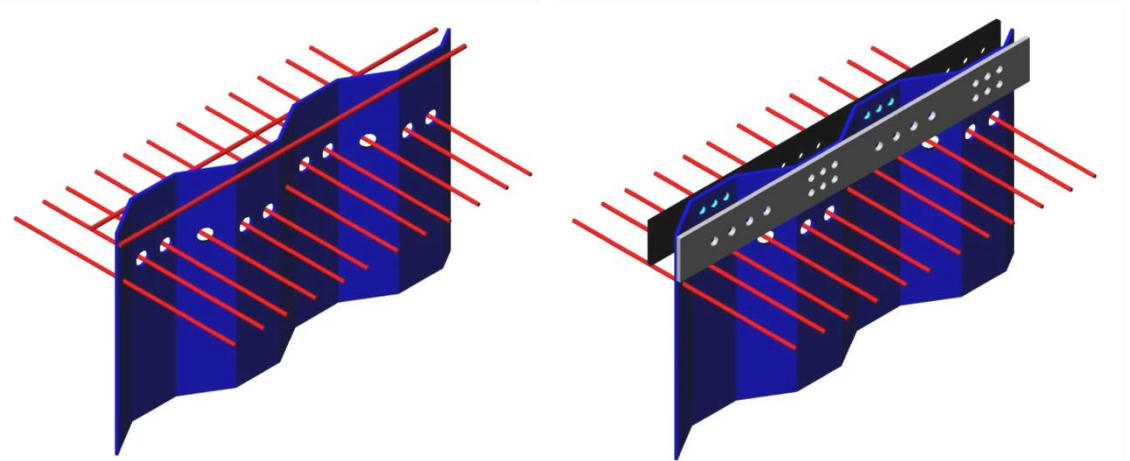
Verbundfuge mit eingebundenem Stahlsteg und Betondübel
